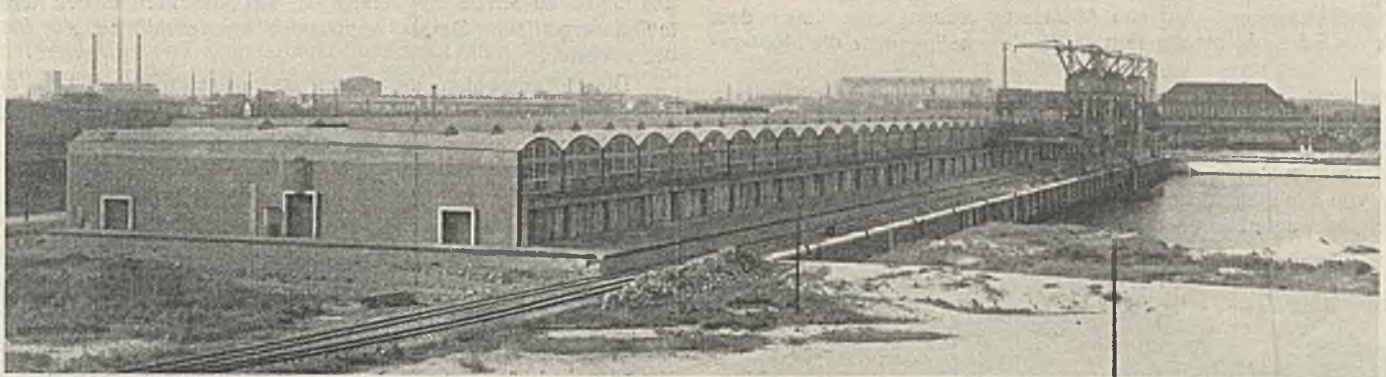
Ansicht von der Wasserseite mit Kranbahn.
